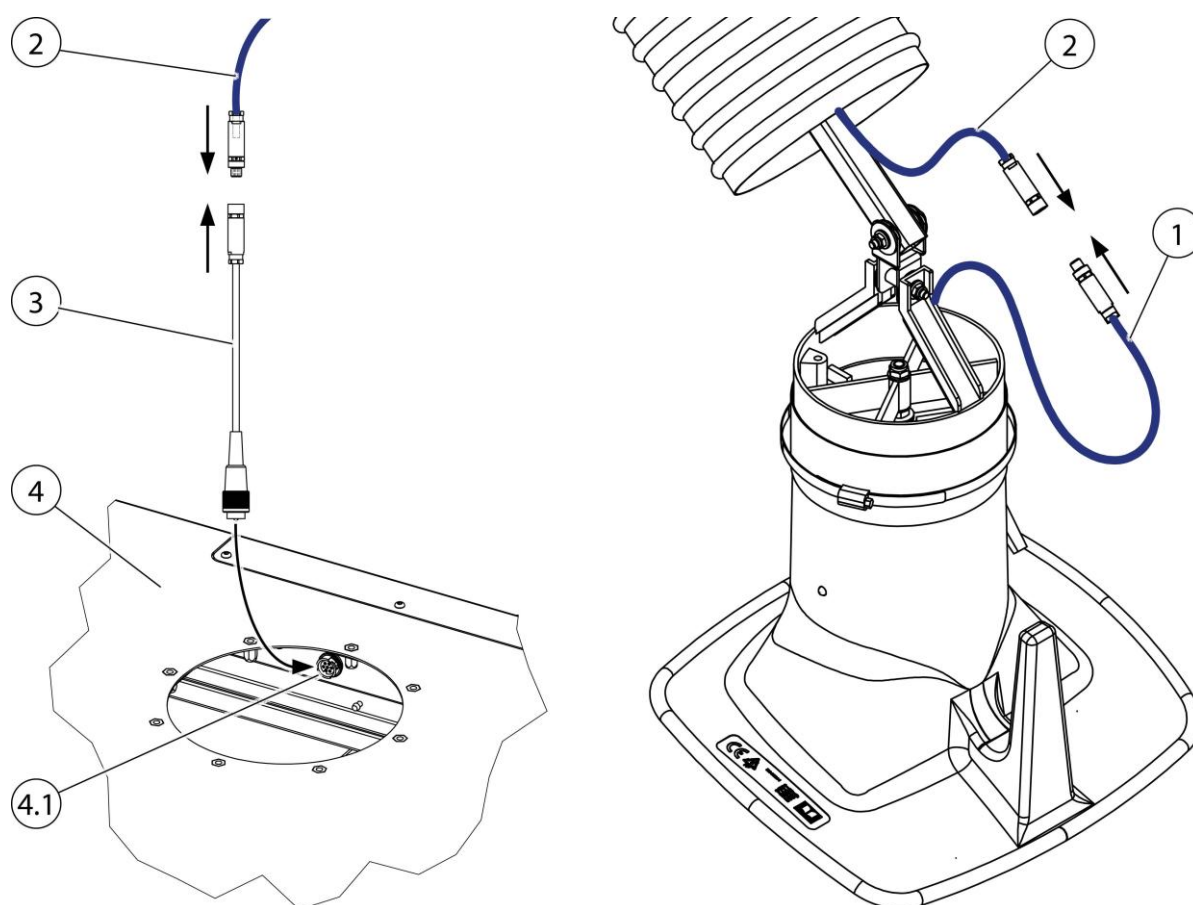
Montagem – Produto com placa de controlo e iluminação
